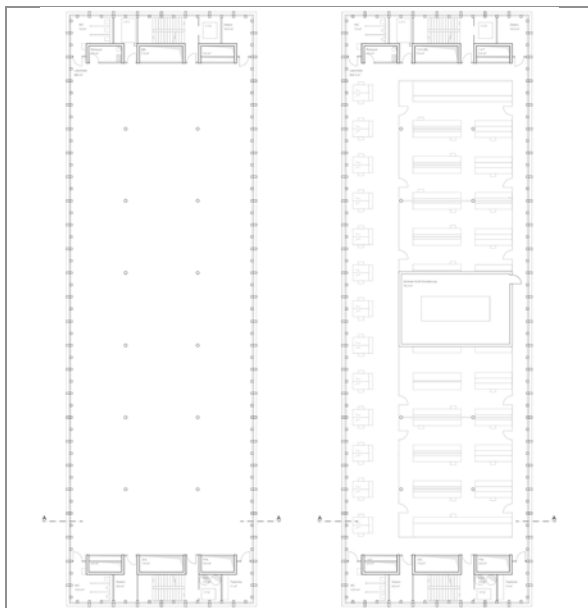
Grundriss 1. Obergeschoss
